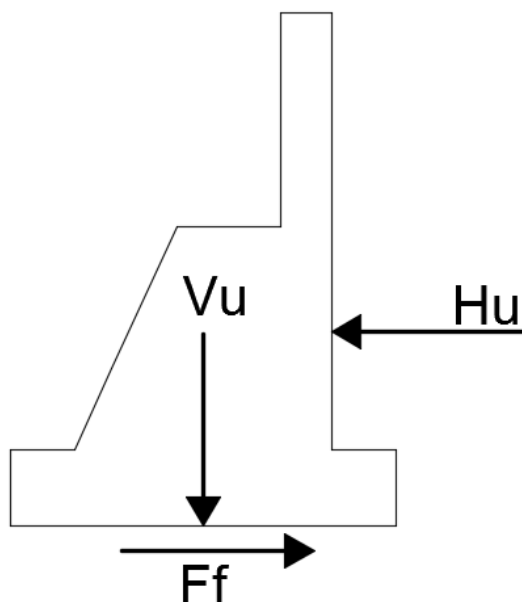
Cargas que provocan el deslizamiento en la base del estribo. Realizado por: Autor
